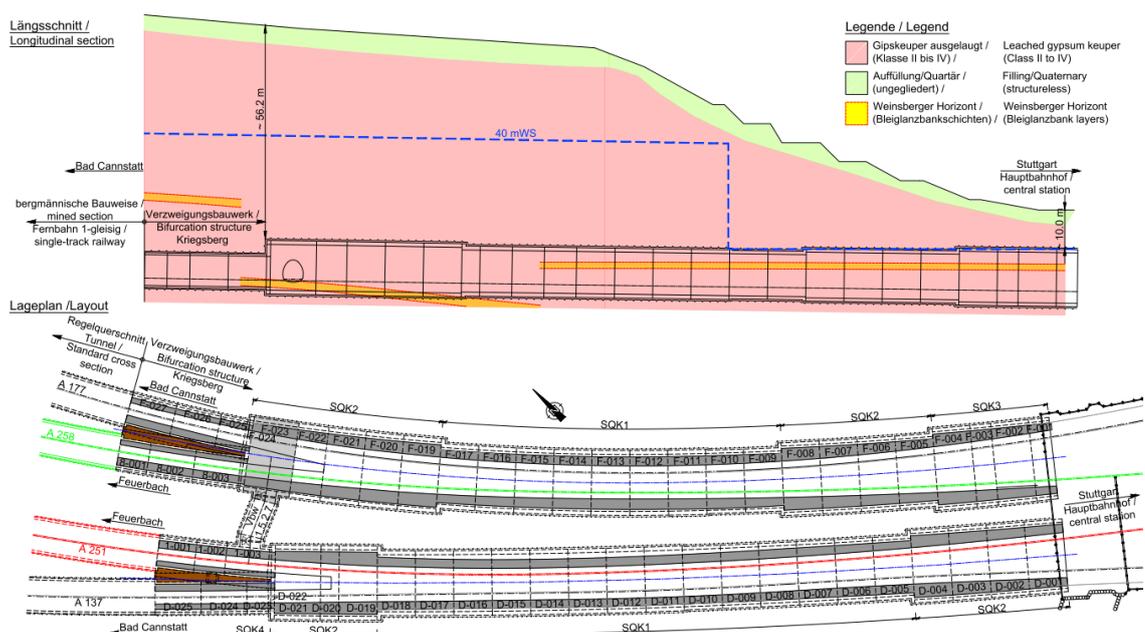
Längsschnitt und Lageplan des Verzweigungsbauwerks Kriegsberg mit Verbindungsbauwerk 1.5.2.7
